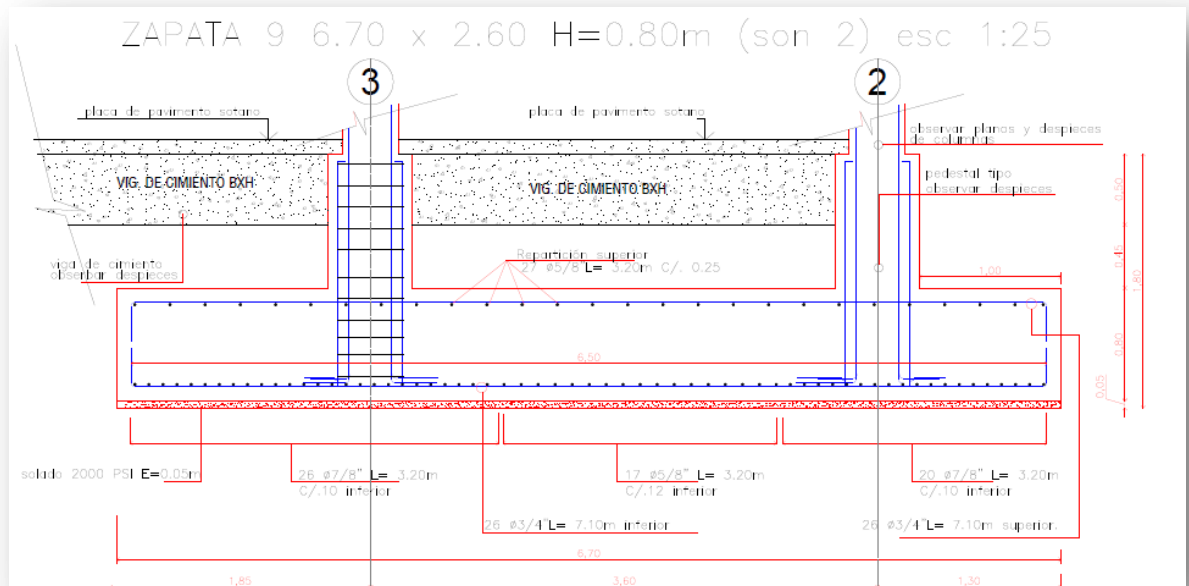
Detalles de Zapata. Fuente: Ing Diego Quiroga
